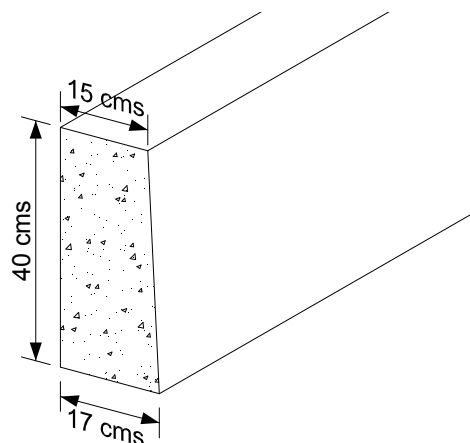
Medidas de Sardinel para Pavimento Flexible
